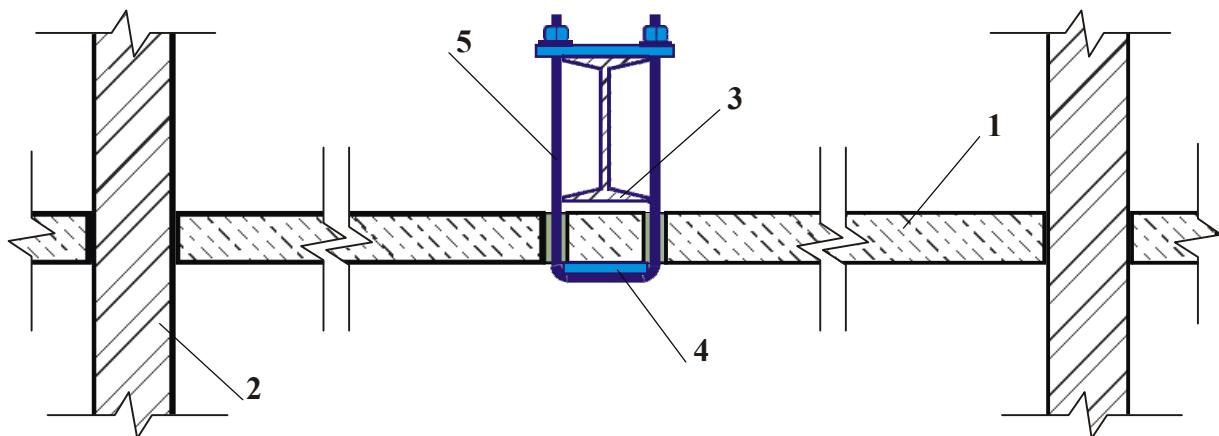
Усунення прогинання перекриття шляхом підвішування до двотаврової балки: 1 – плита перекриття; 2 – перегородка; 3 – несуча балка; 4 – розподільна підкладка; 5 – сталевий хомут
